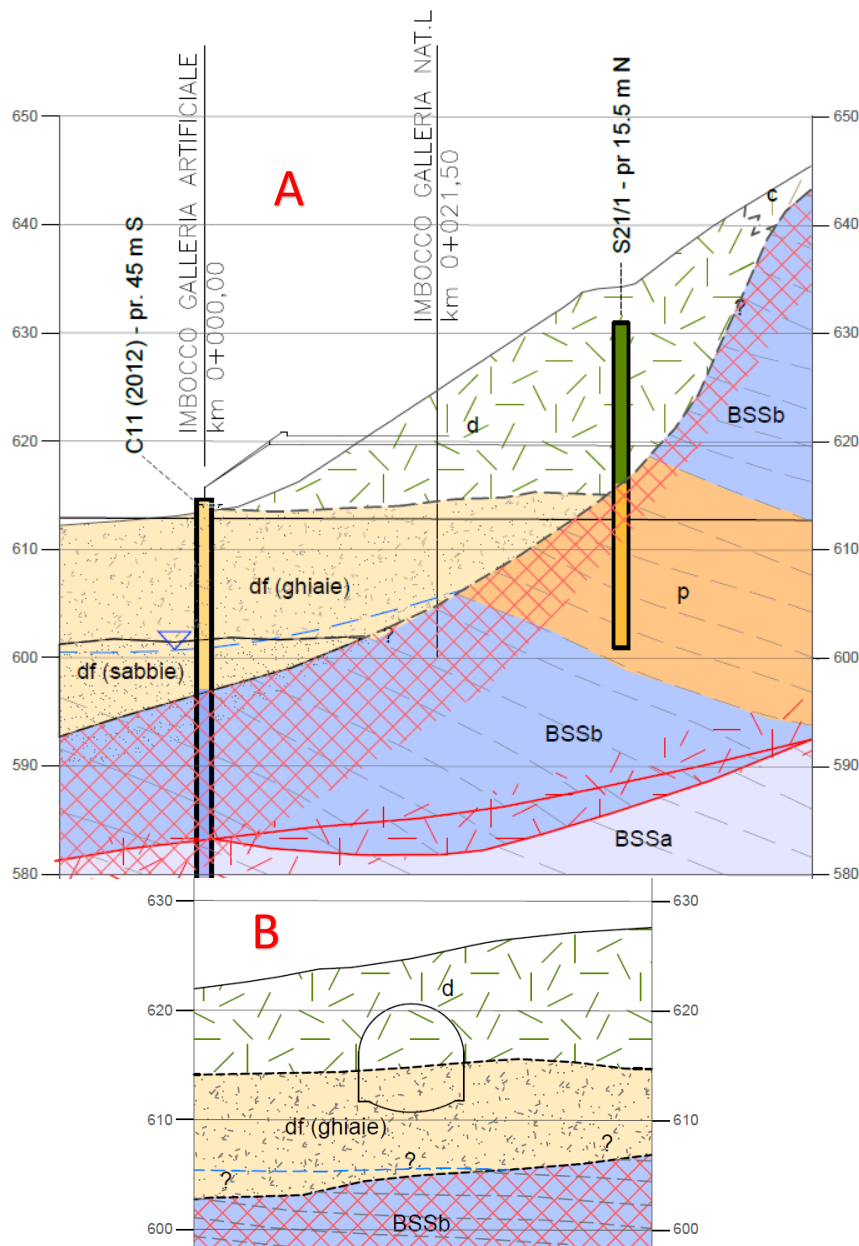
stralcio del Plano-Profilo allegato con le sezioni geologiche longitudinale (A) e trasversale (B) dell'imbocco della finestra di Chiusa.
